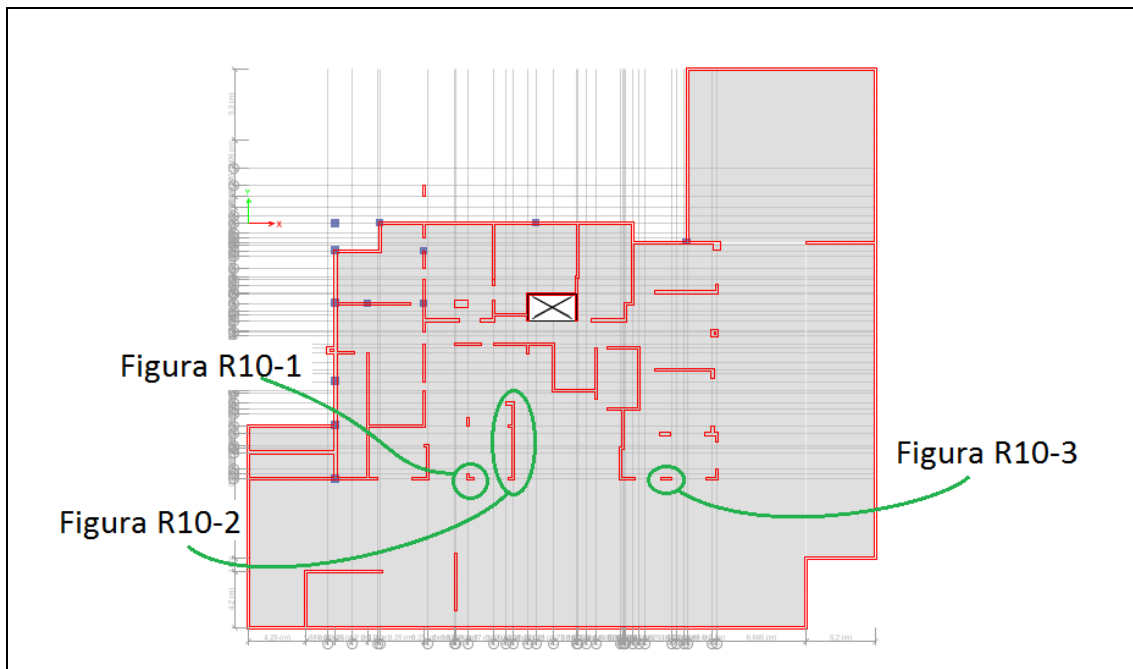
Planta del subterráneo del edificio R10, se indican los elementos dañados
